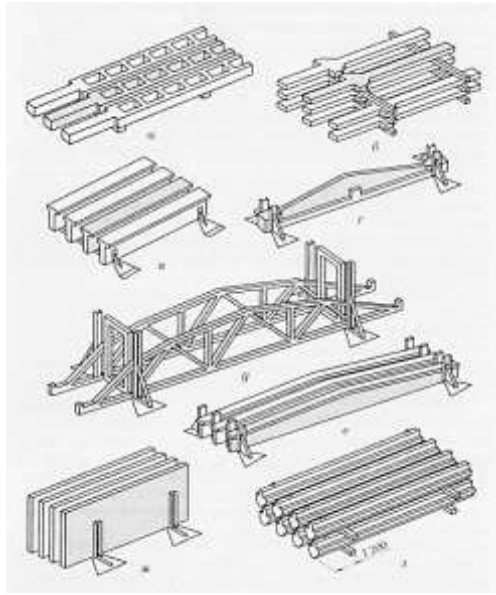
Складирование железобетонных конструкций промышленных зданий: а — колонн одноэтажных зданий; б — колонн многоэтажных зданий; в — подкрановых балок; г — подстропильных балок; д стропильных ферм; е — стропильных балок; ж — стеновых панелей; з — ригелей
